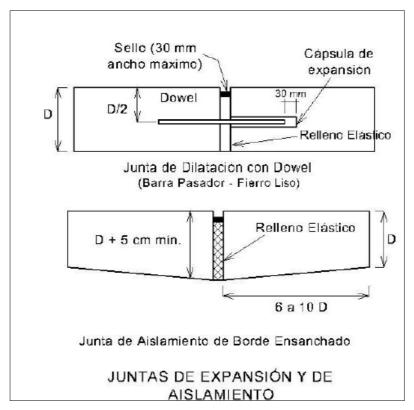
Juntas de Expansión y Aislamiento Fuente: Norma CE.010 Pavimentos Urbanos
